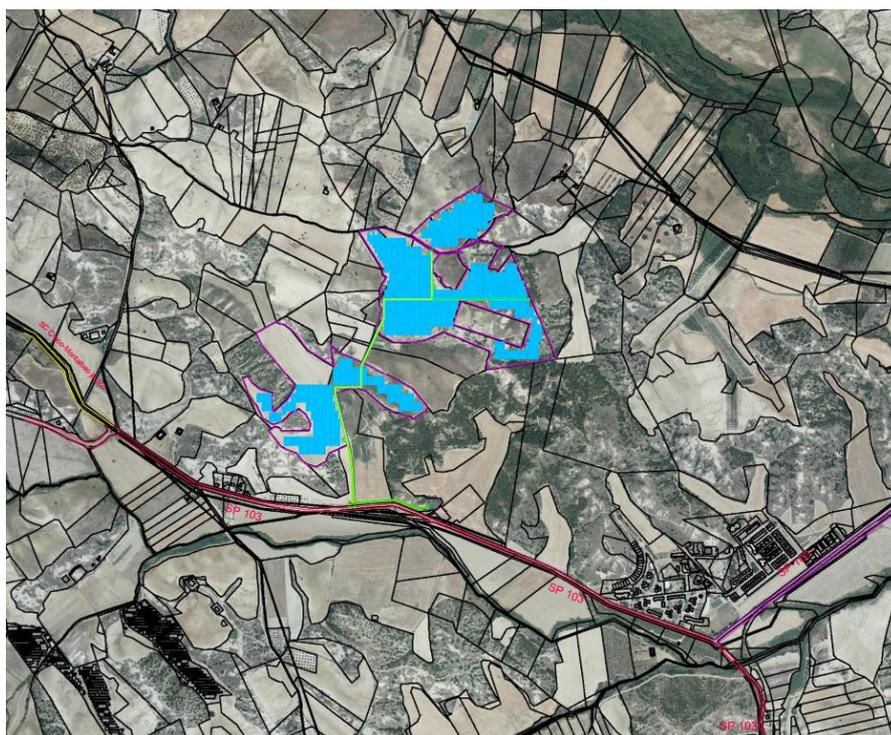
Layout dell'impianto fotovoltaico su ortofoto.
